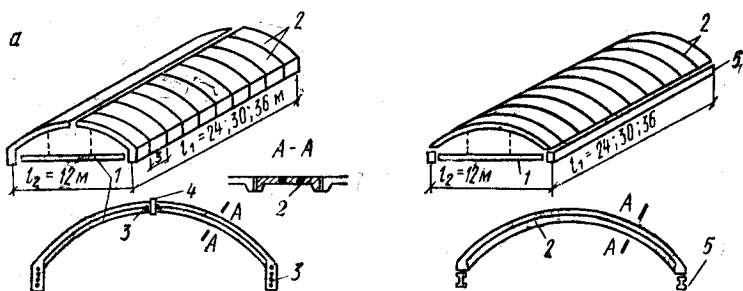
Конструктивные схемы сборных покрытий с длинными цилиндрическими оболочками
